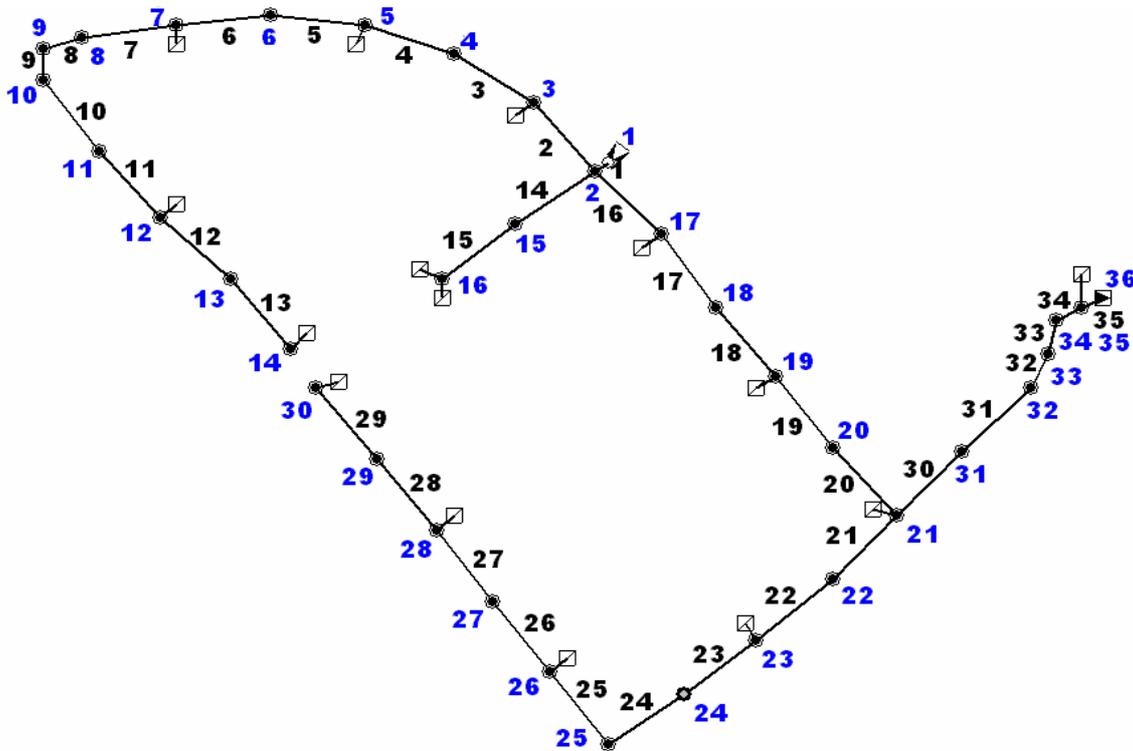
Detalle de la instalación de alcantarillado y numeración de nudos y ramas
